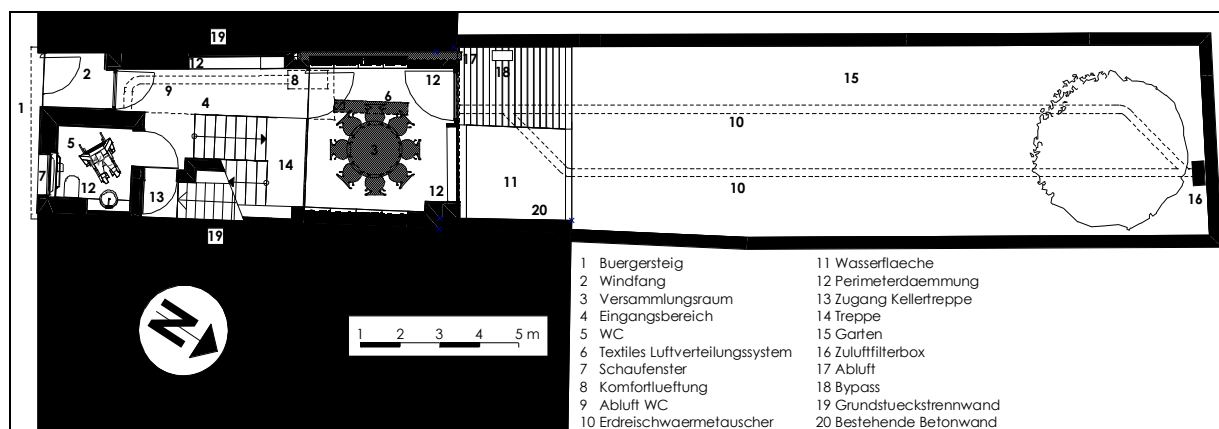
Grundriss Erdgeschoss.
